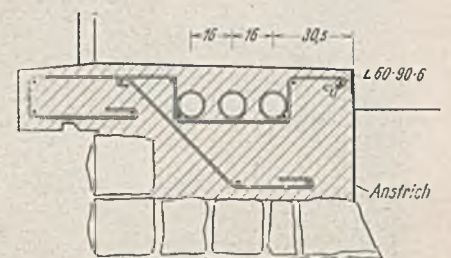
Schnitt durch die Flügelmauer aus Bruchstein mit Winkelseisenschrammbord. Anstrich
